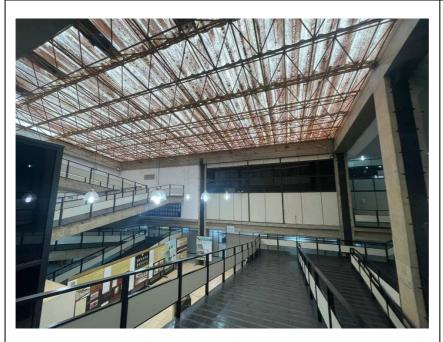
Cobertura do saguão que será removido e instalado novo modelo.
